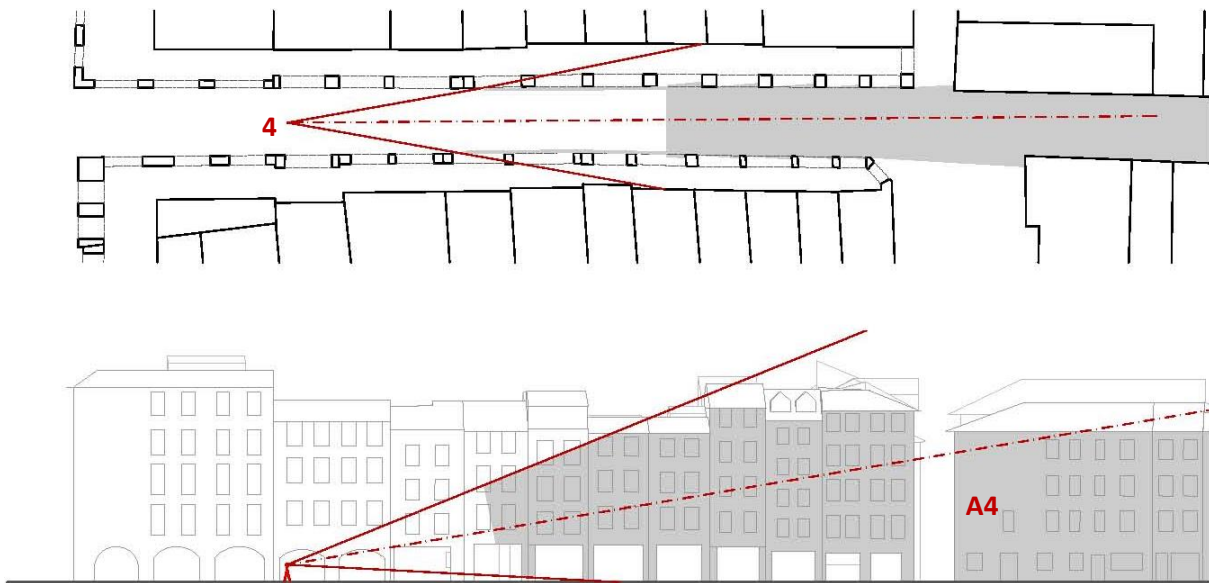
17. Esquema en planta y alzado del área abarcada en una termografía en la dirección rasante a la fachada realizada desde la posición 4 en la Rue des Tonneliers de Bayona
